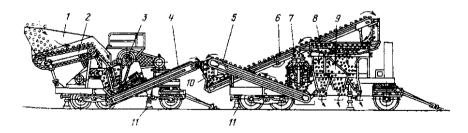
Двухагрегатная дробильно-сортировочная установка
